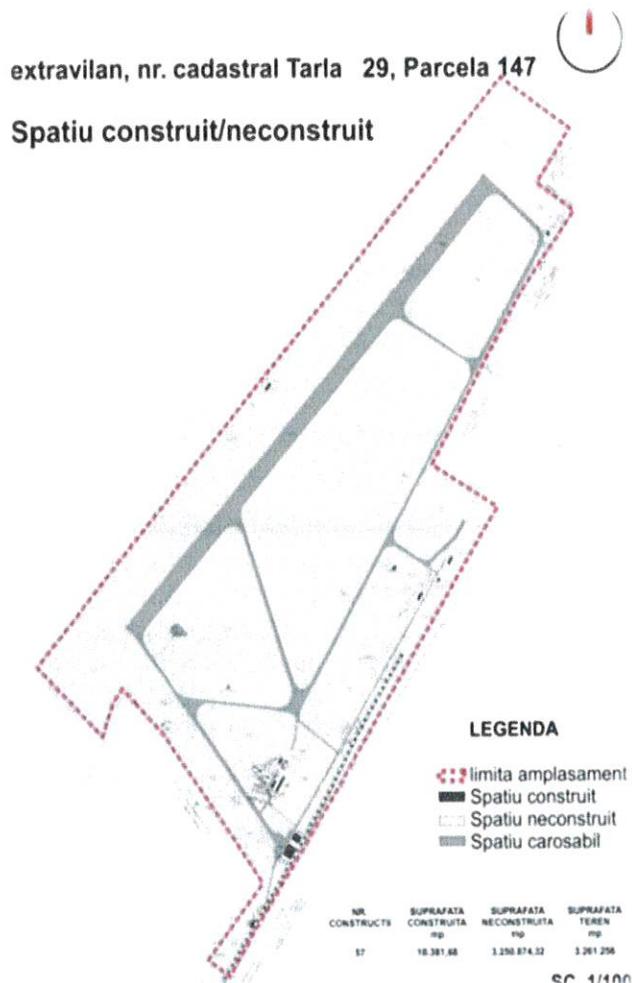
Tarla 29, parcela 147, nr. cadastral 251, Spațiu construit – neconstruit
